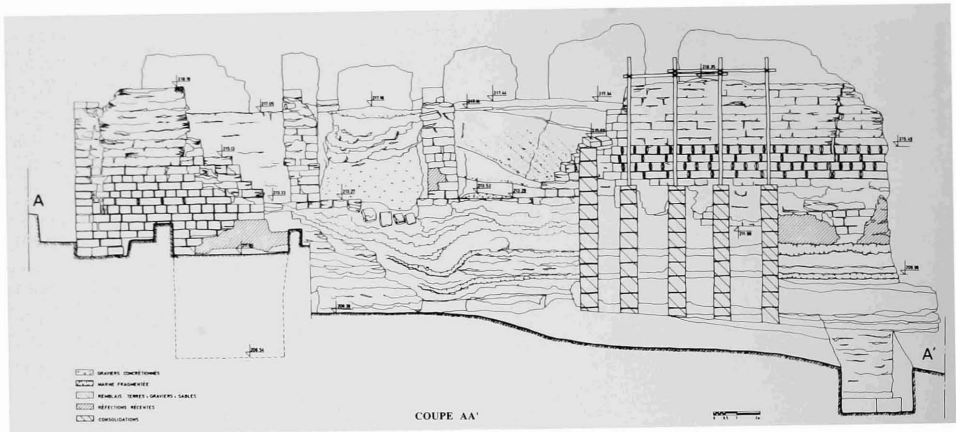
Palais du Stratège. Élévation de la façade nord. Coupe AA'. Dessin F. Bodet, d'après P. Royère
